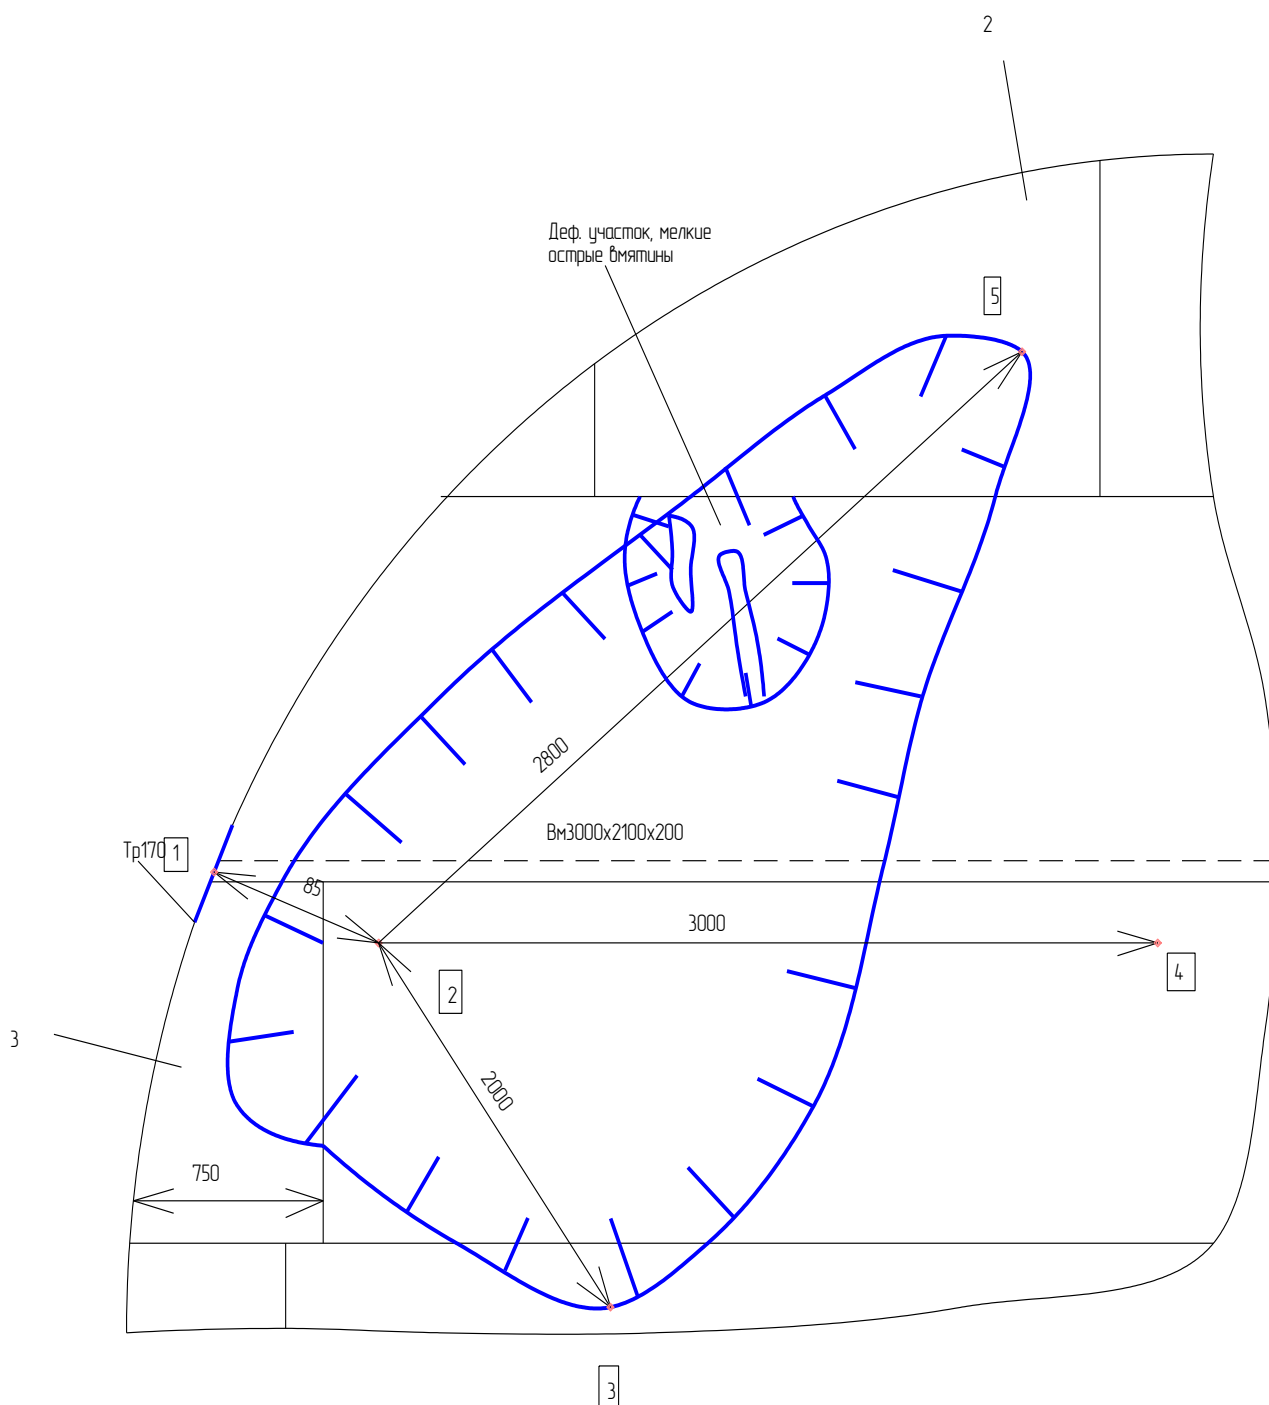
Схема расположения вмятины. 1, 2, 3, 4 – Точки измерения неравномерной осадки дна резервуара в месте образования вмятины
